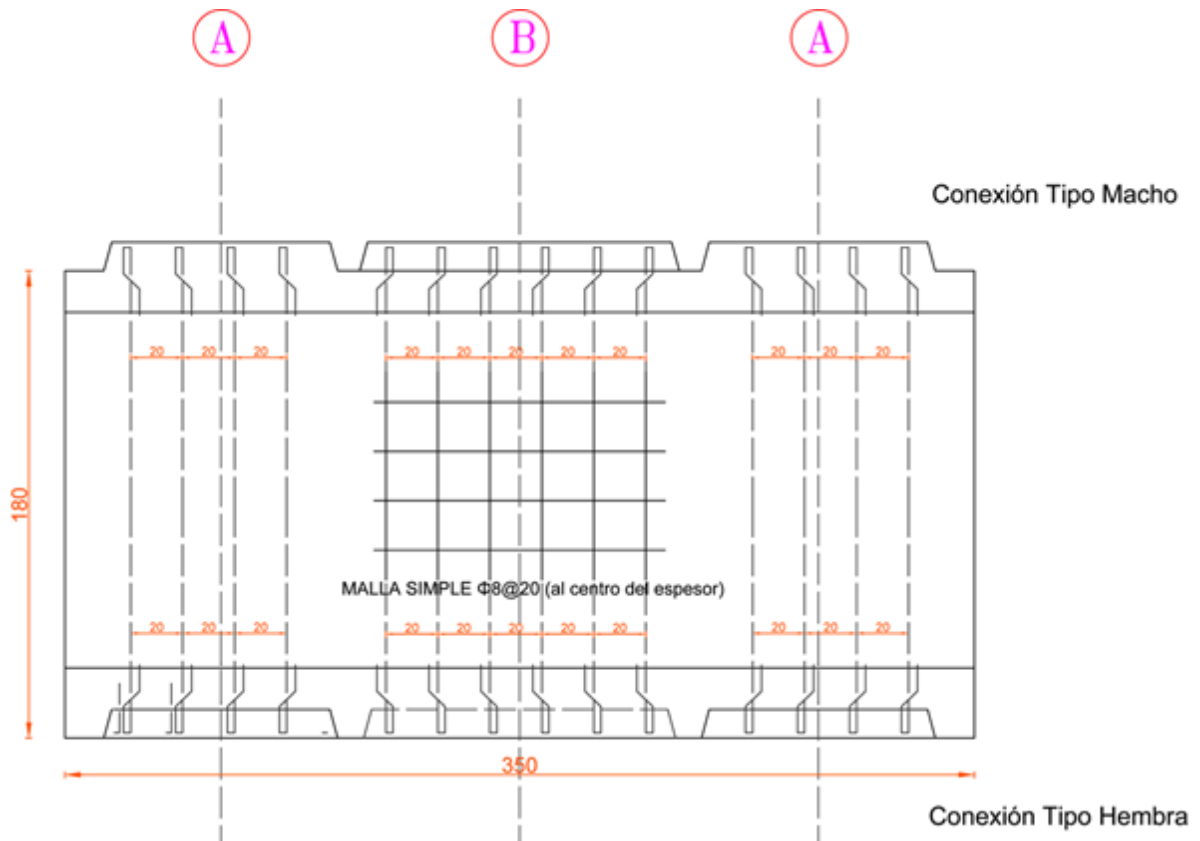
Losa de sistema machihembrado con conexión tipo hembra y tipo macho.
